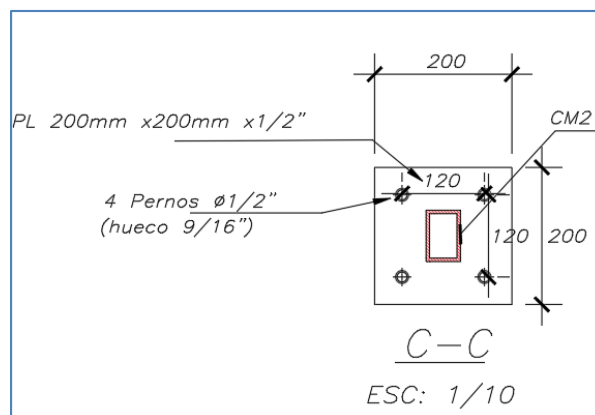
DETALLE ESTRUCTURAL DE PLANCHA BASE Y PERNOS DE TIRANTE CM1
